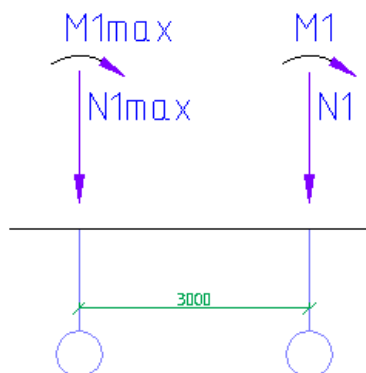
Схема приложения нагрузки от ветвей продольной рамы
